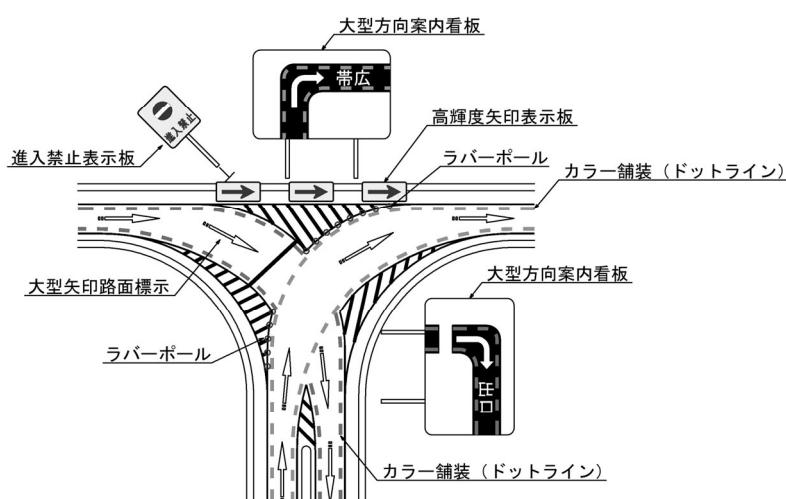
平面Y型IC平面交差点部 逆走対策工配置図（参考）
